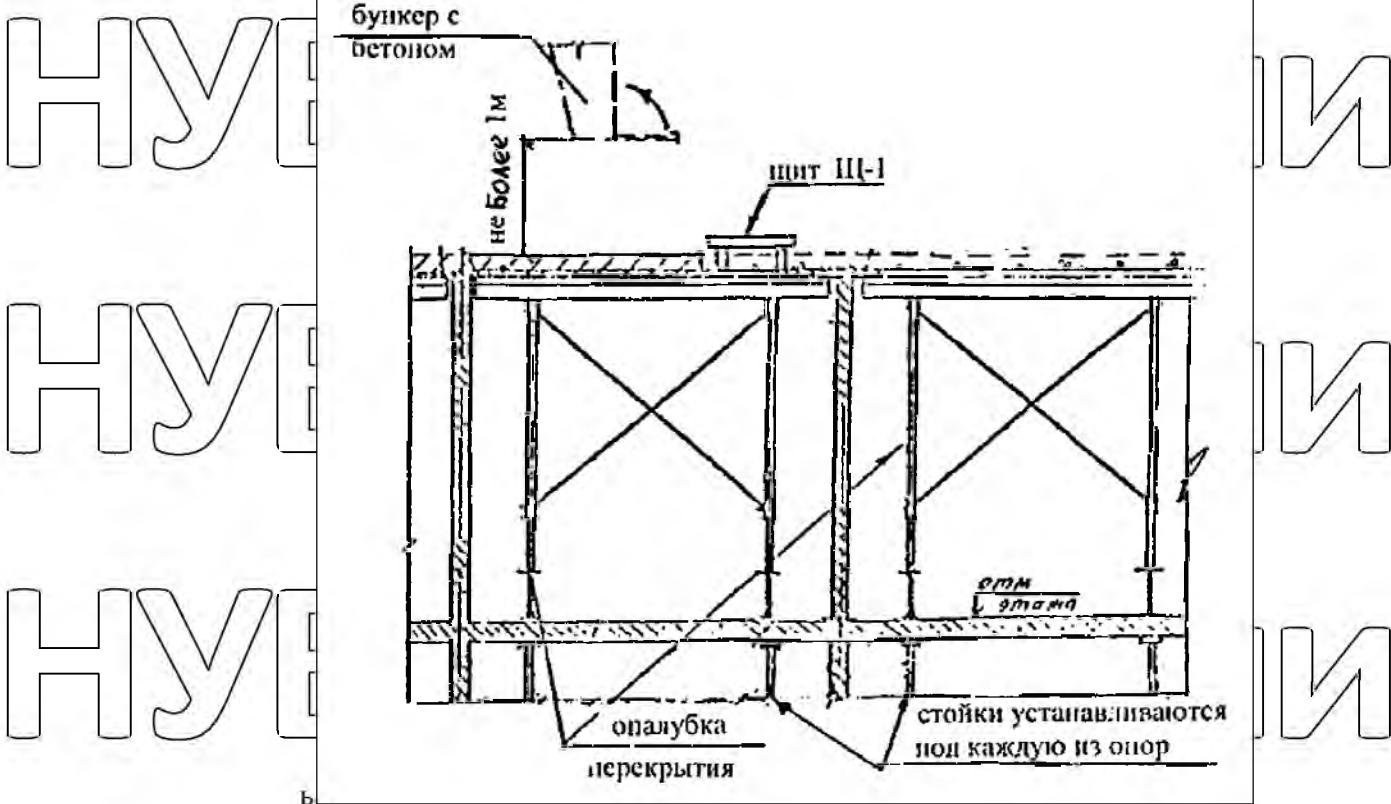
Вивантаження бетонної суміші з бункера в опалубку
